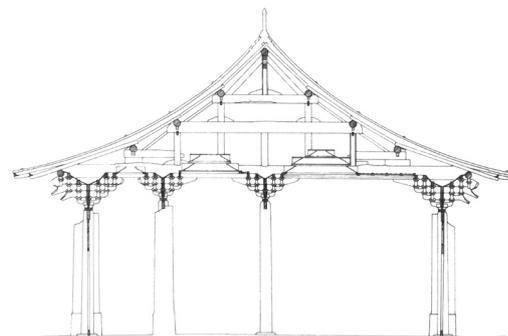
Sección constructiva del Templo Yongle Gong.
